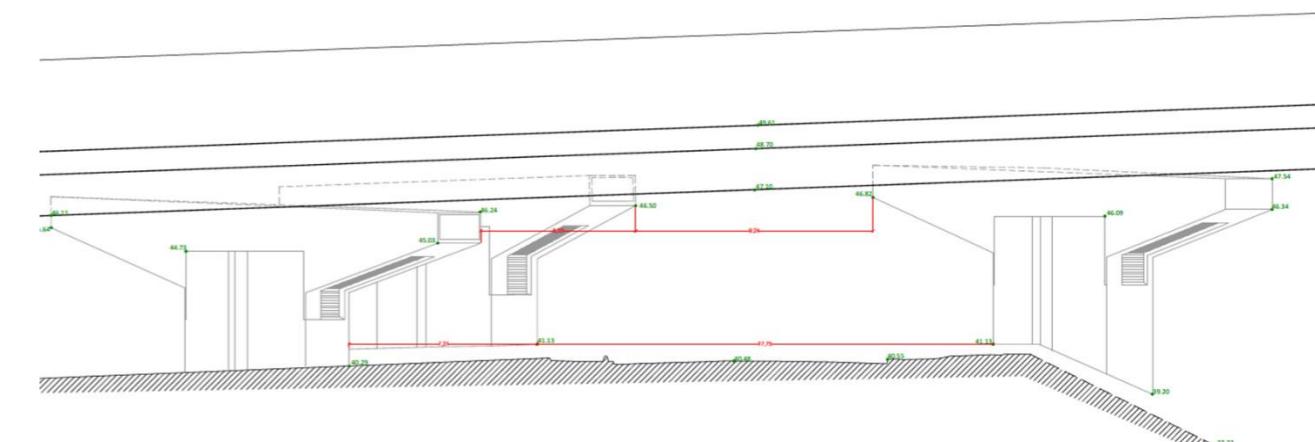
Coupe en travers de l'ouvrage pont-route de l'A86 franchissant le canal Saint-Denis et la RD30
